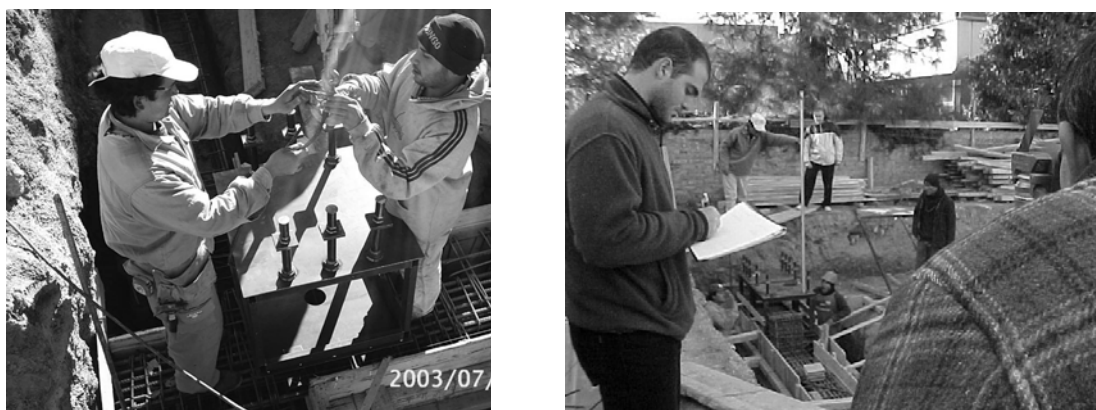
Excavaciones y estructura de fundación por debajo de los dispositivos de aislamiento.
